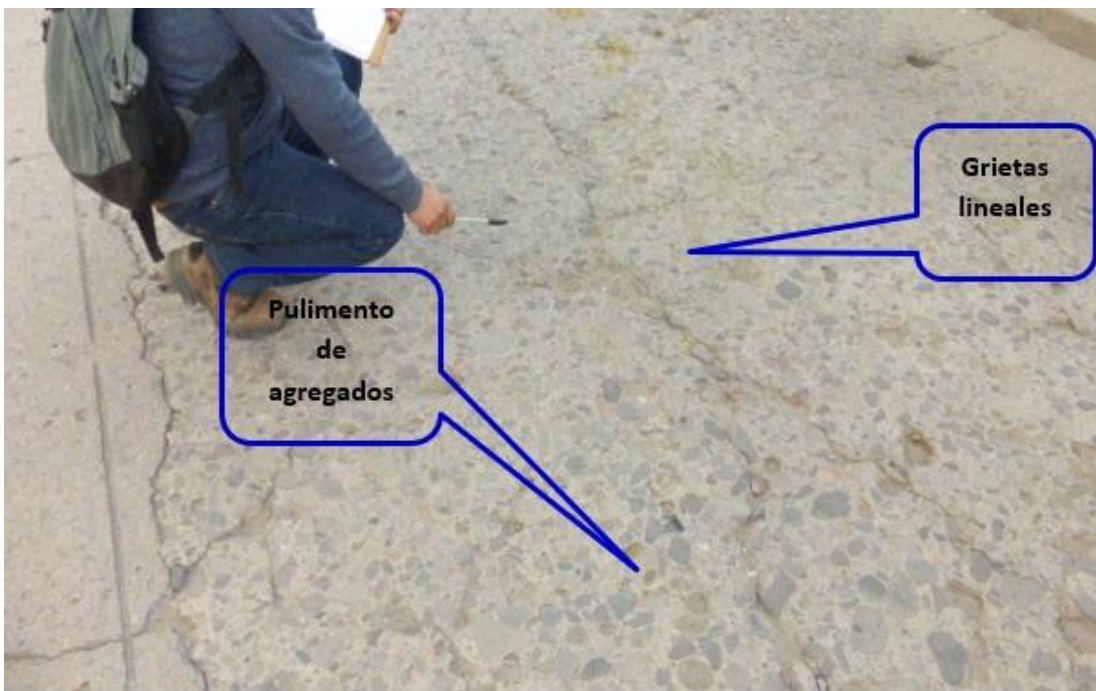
Grietas lineales de baja severidad y pulimento.
